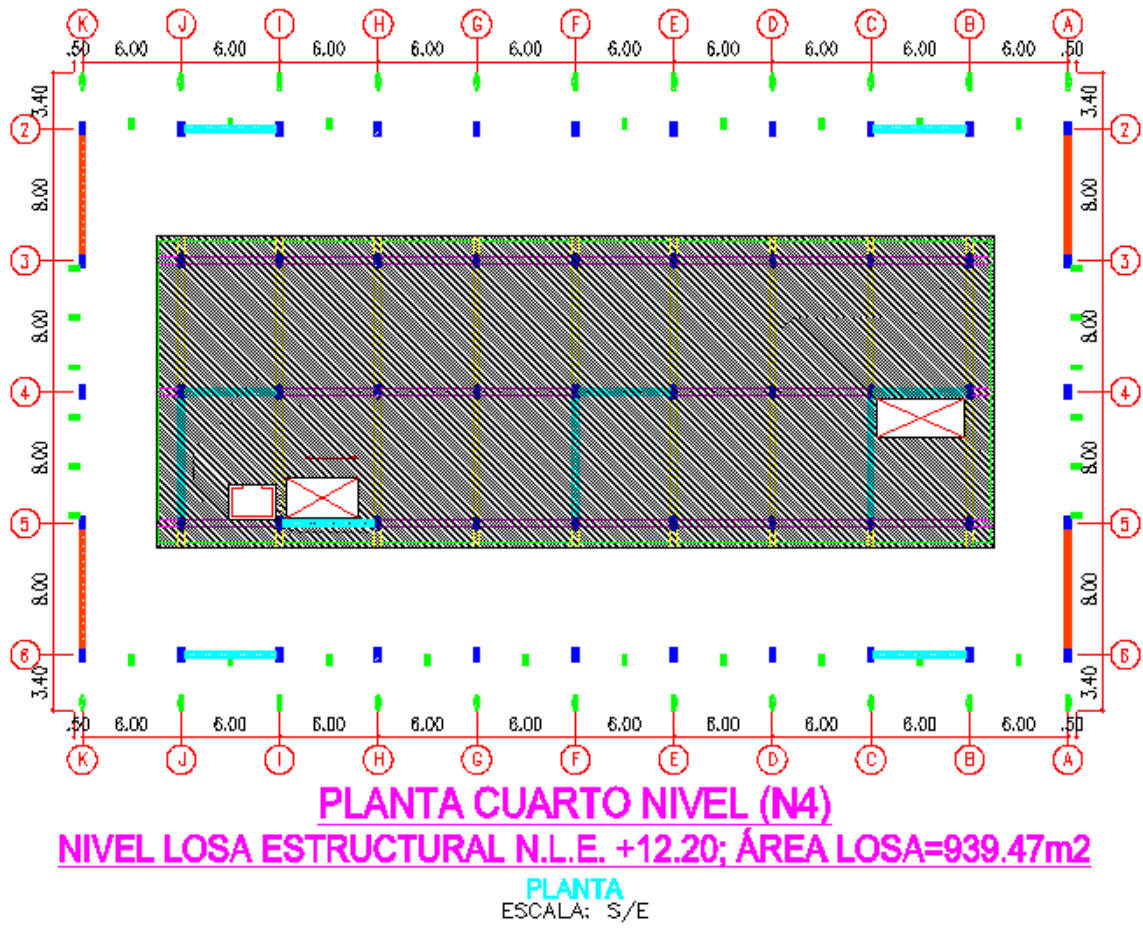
Planta cuarto nivel – N.L.E. +12.20m – área de losa (diafragma)= 939.47m²
